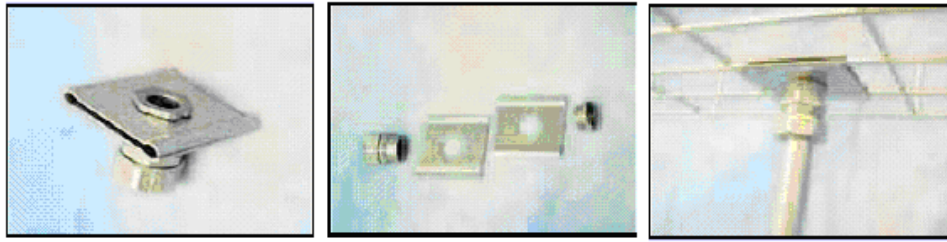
Accesorios para acople entre ductos Conduit y Canasta metálica.
